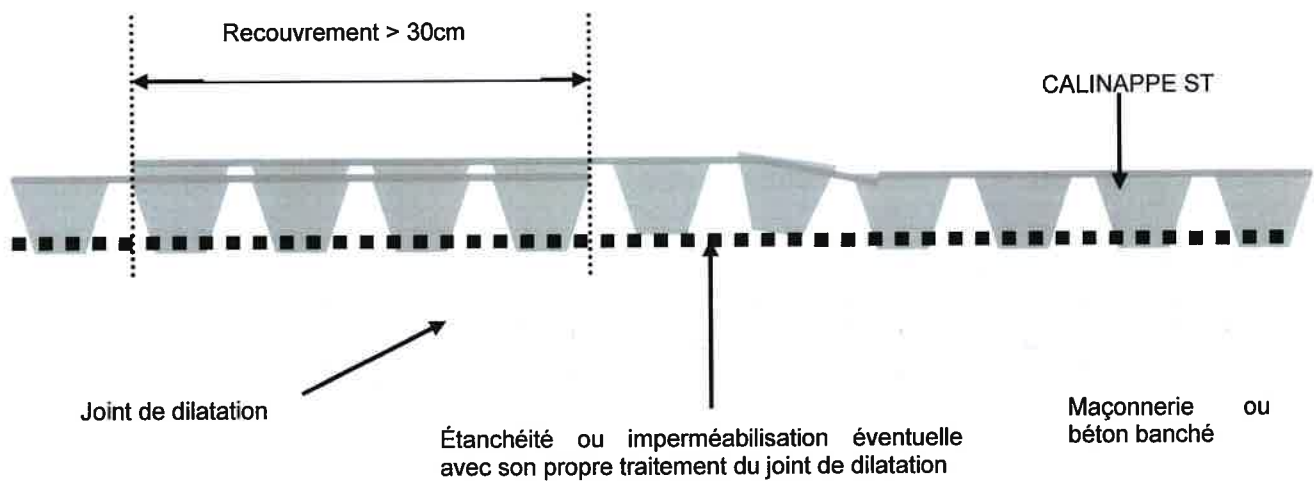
Joint de dilatation - Recouvrement du dernier lé (coupe horizontale)
